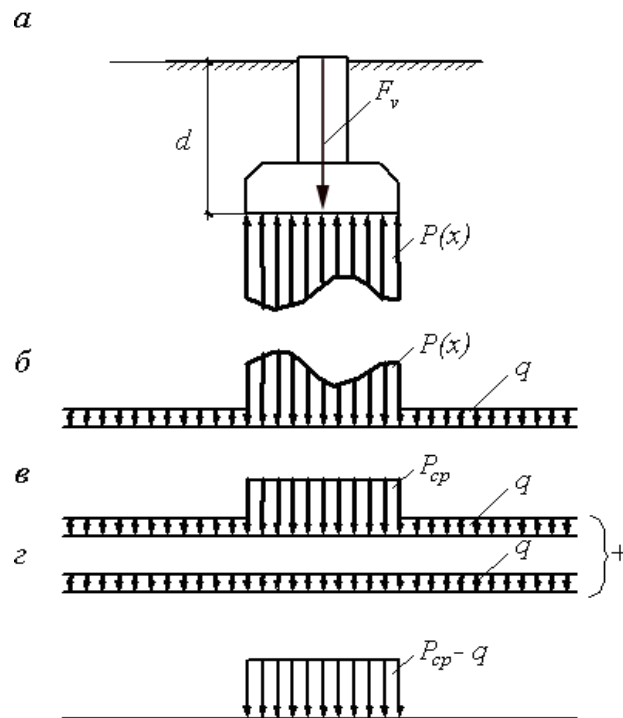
Схеми до дії навантажень на основу фундаменту
